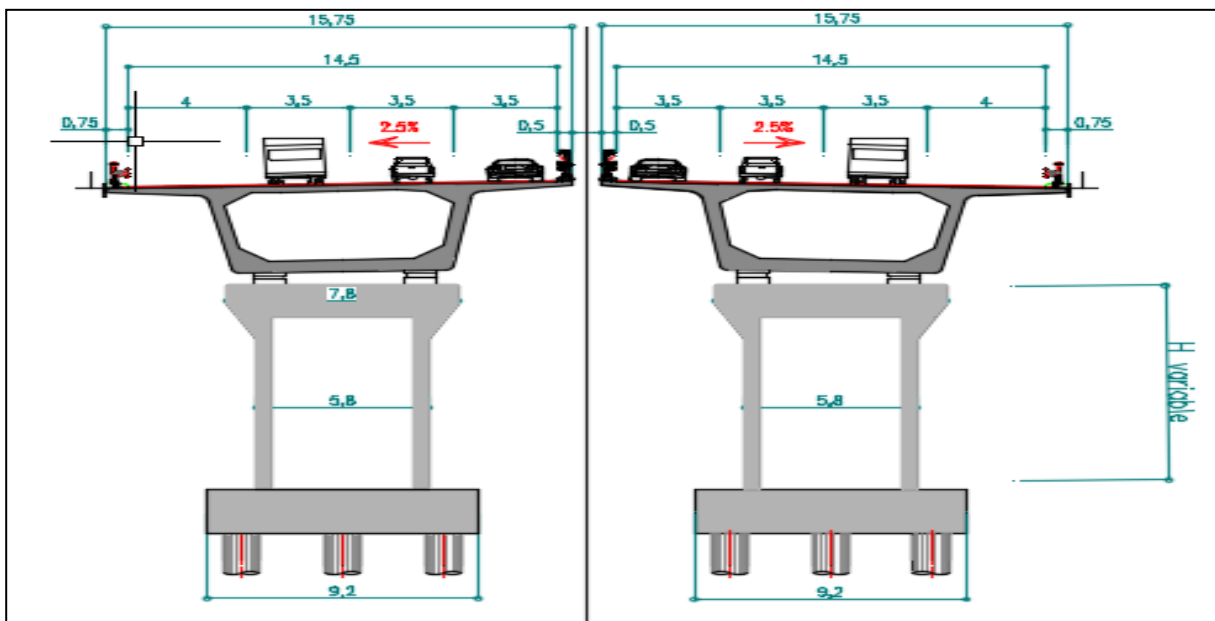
Coupe transversale sur pile VARIANTE 02
